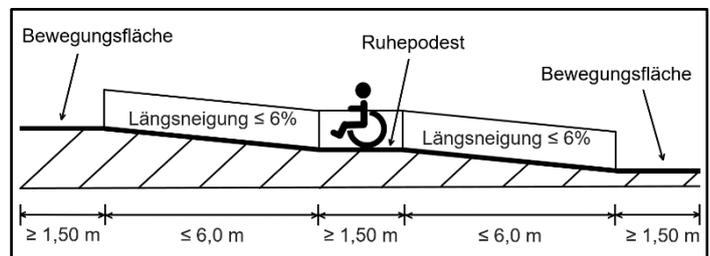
Schematischer Aufbau einer Rampe mit Ruhepodest nach jeweils 6 m Rampenlänge
